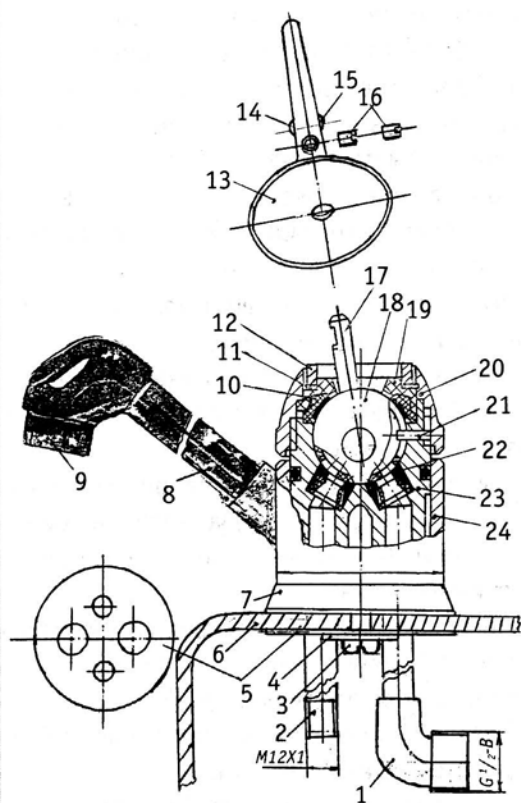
Однорычажной напорный смеситель с металлическим запорным шаром для мойки типа См-МОРА:
